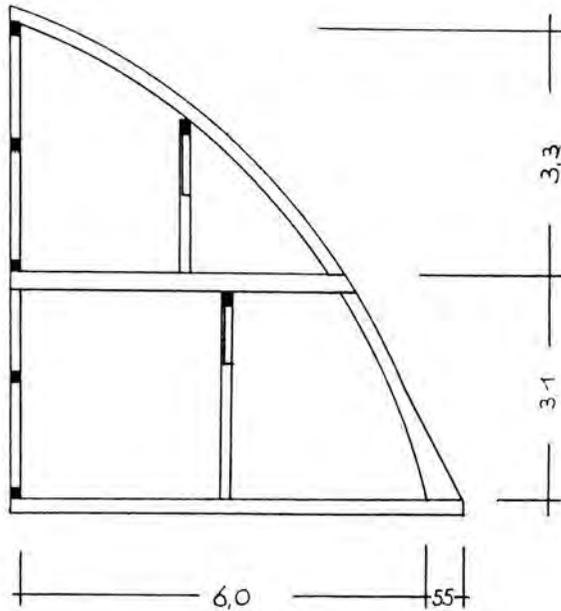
Schwerin, Münzstraße 27, Hofgebäude, Querschnitt des Daches, aus /33/
